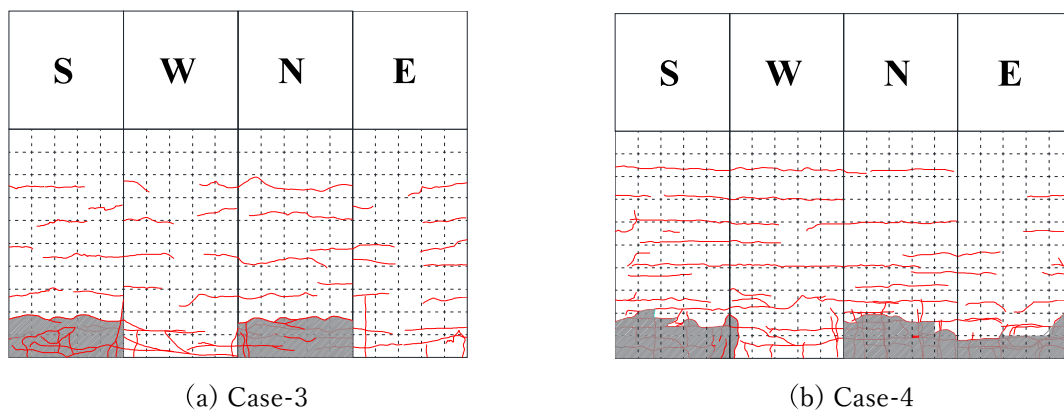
4.0%ドリフト(64 mm)時の供試体ひび割れ進展状況
